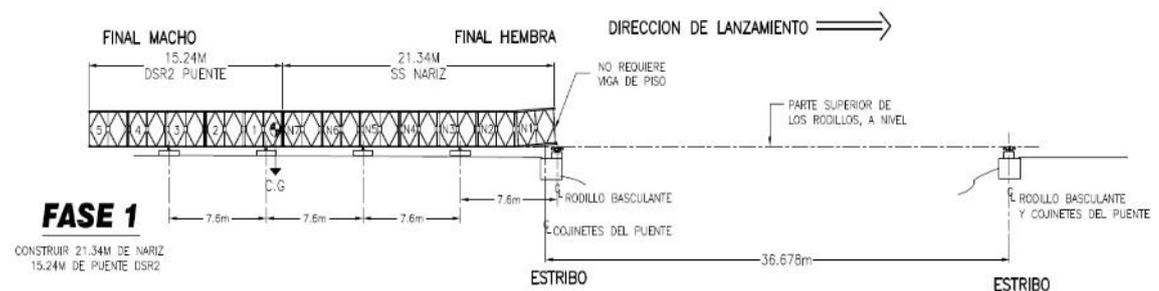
Montaje de puente modular L= 15.24 m y nariz de lanzamiento
